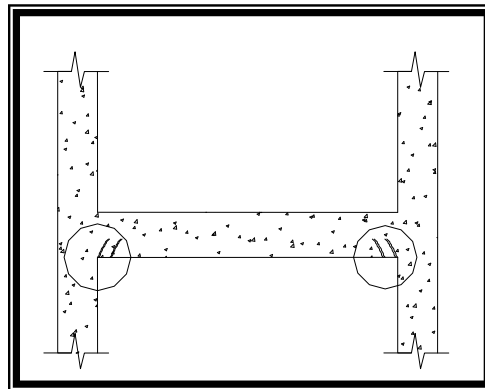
Grietas inclinadas aprox. 45° en los extremos de la viga (Falla por corte)
